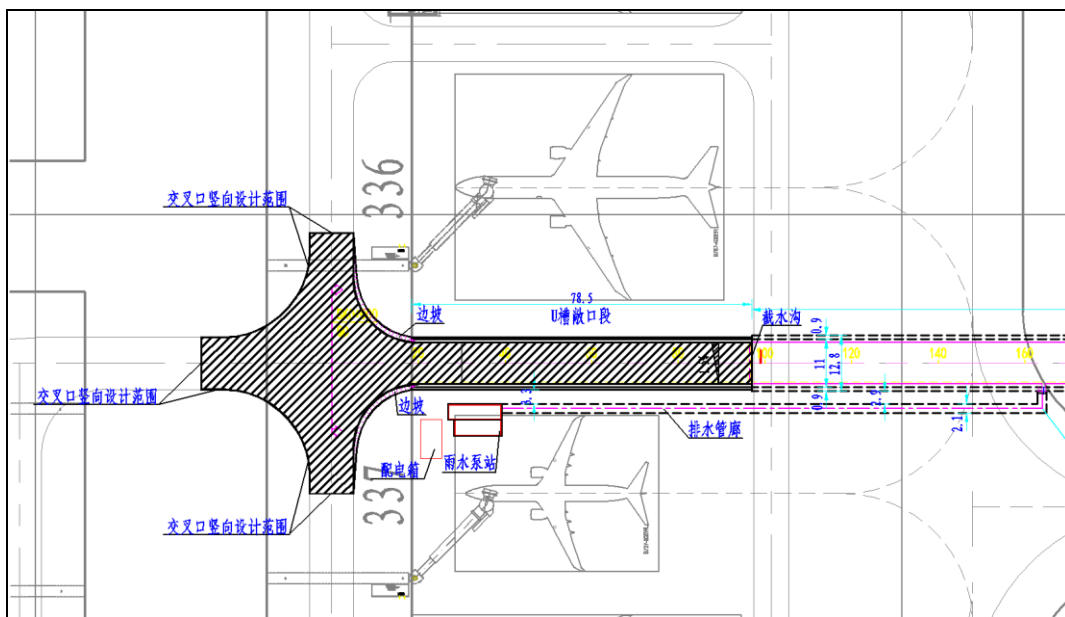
2 号下穿通道入口改造区域平面示意图
